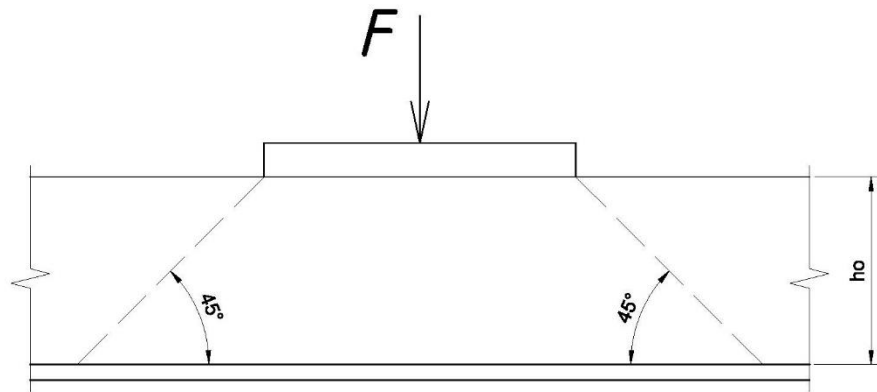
До розрахунку на продавлювання плити перекриття
